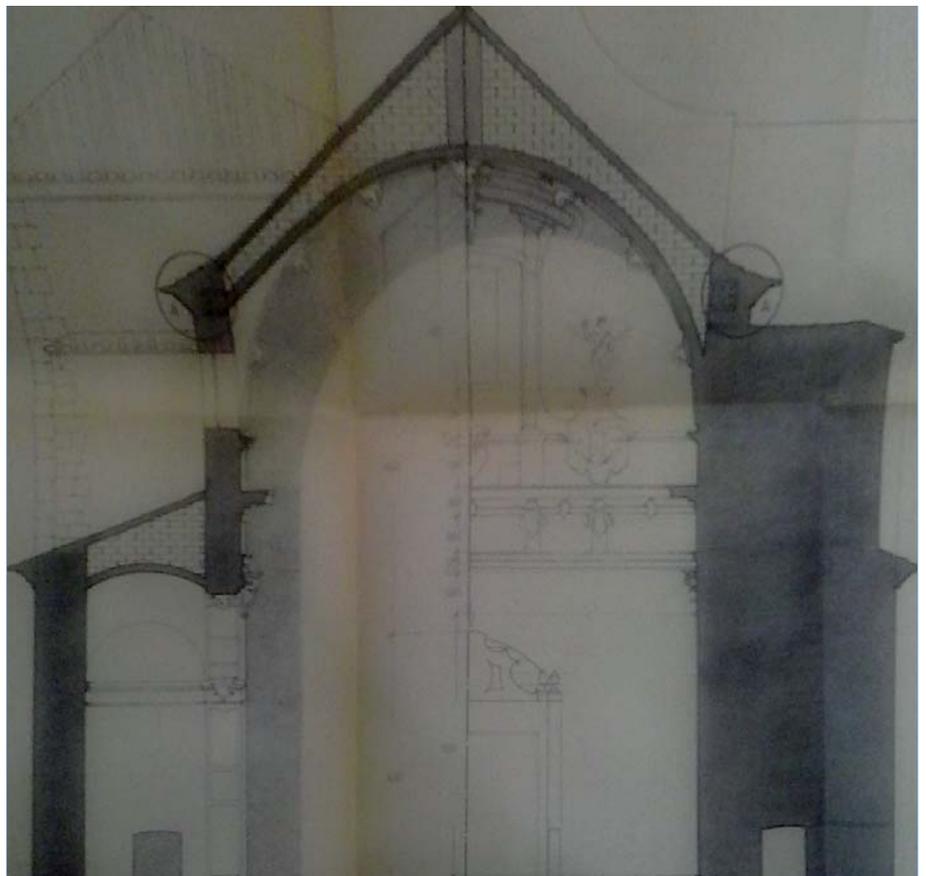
Sección constructiva del proyecto de Arturo Zaragoza.
